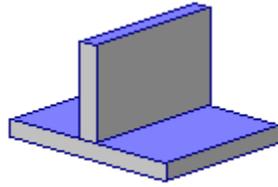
Zapata Corrida, Concreto, Interna o No Colindante
